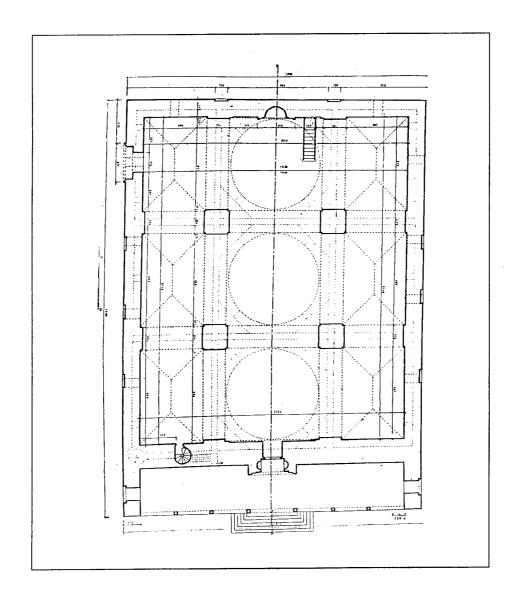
مسقط أفقي وقطاع لمسجد غازي خسرو بك في سراييفو (عن :Pašić) .
